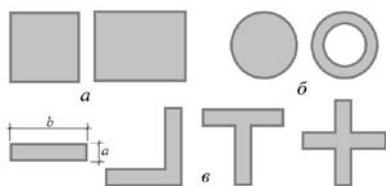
Виды поперечных сечений железобетонных колонн монолитных многоэтажных зданий массовой застройки: *а* – квадратное (прямоугольное), *б* – круглое (кольцевое), *в* – уголковое, тавровое, крестовое.
